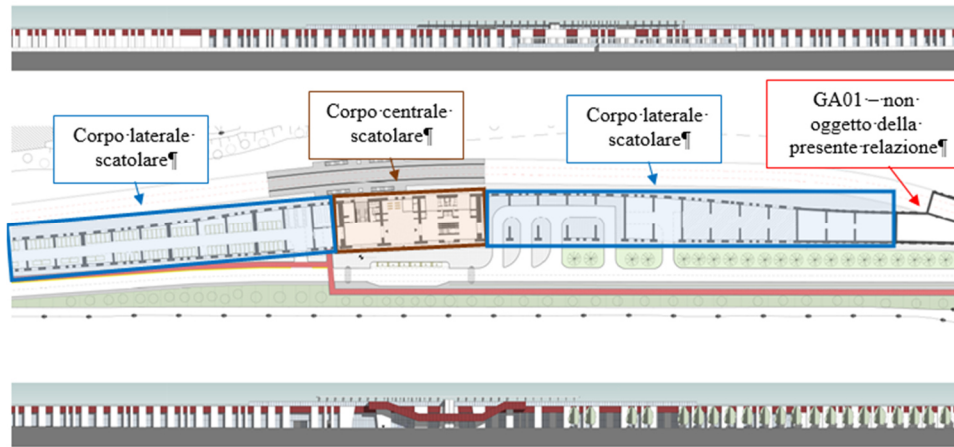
Inquadramento generale (pianta e prospetto architettonici)
